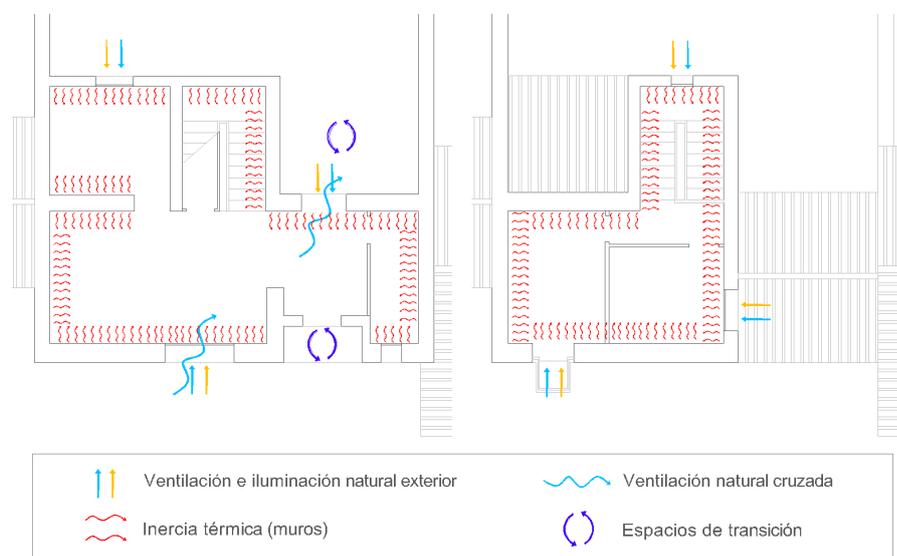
Esquema de las posibles estrategias bioclimáticas en planta; izquierda planta baja, derecha planta alta (Elaboración propia tomando como referencia los planos originales del proyecto)
